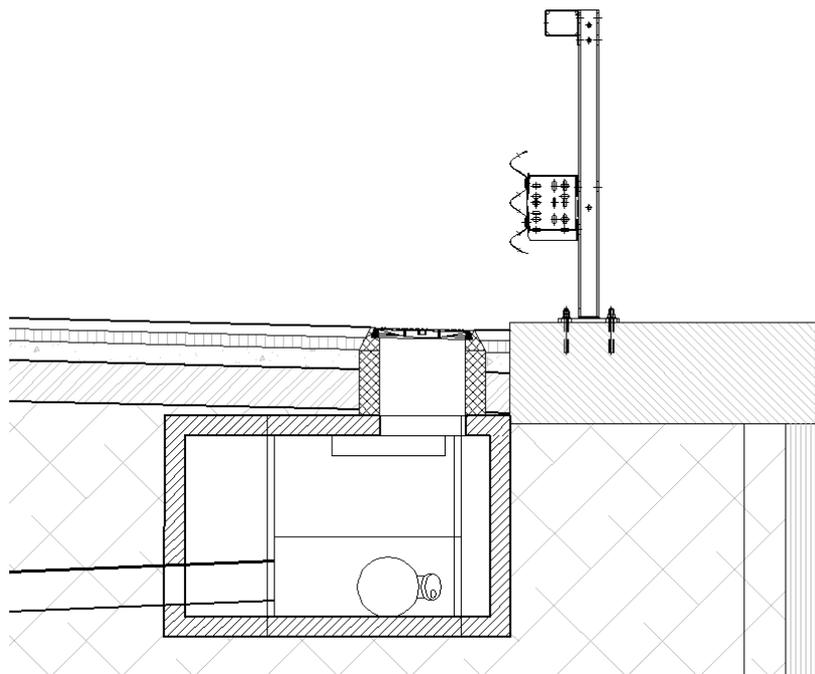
Pozzetto di raccolta con attraversamento delle acque di seconda pioggia (pianta e sezione)
